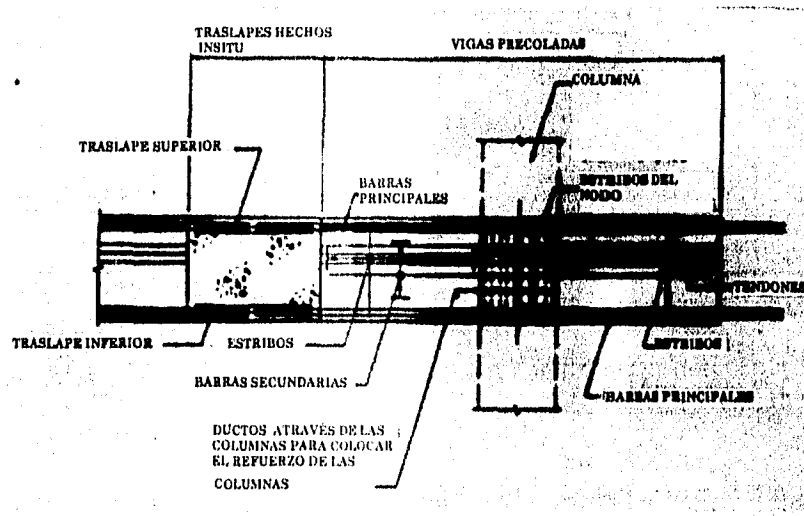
Elevación de las vigas precoladas (tomado de la Ref.(15))
